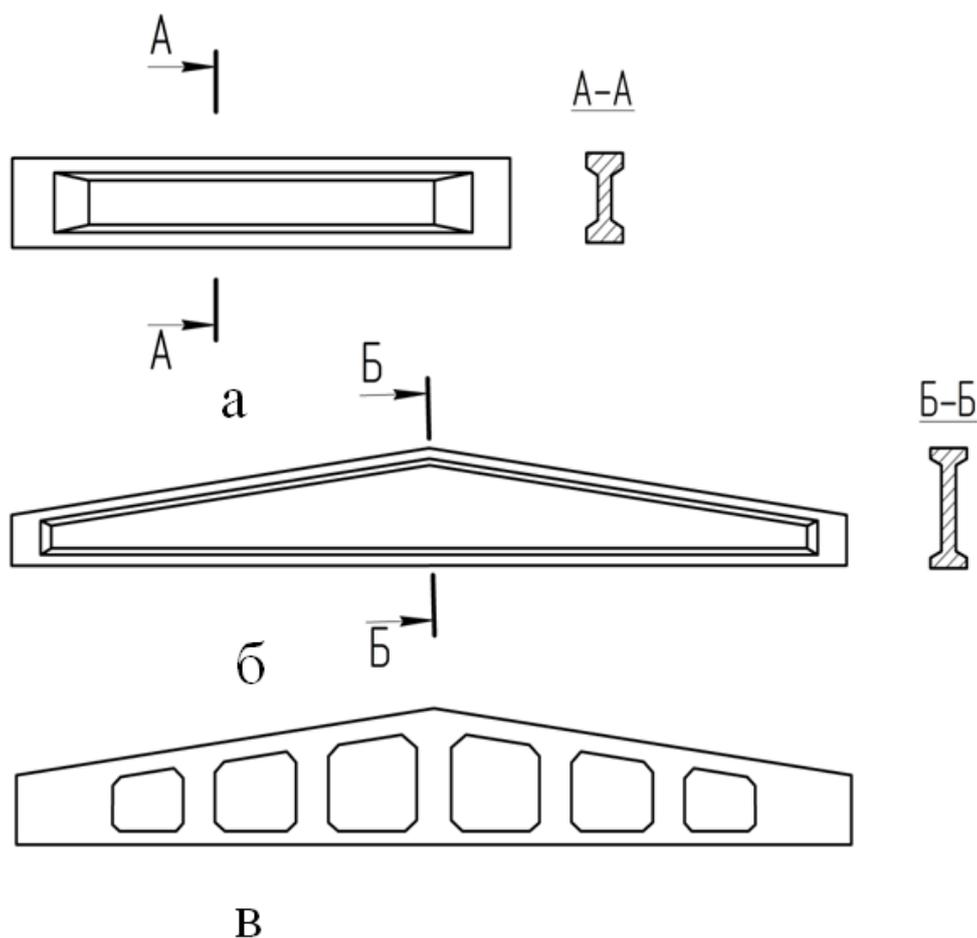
Железобетонные стропильные балки: а – двутавровая для покрытий с плоской кровлей; б – двутавровая для покрытий с уклонной кровлей; в – решетчатая
